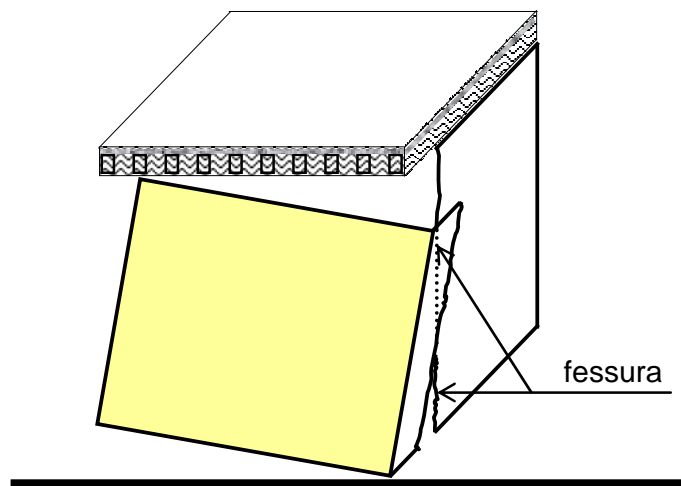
d. L'edificio è assoggettato a un'azione sismica che fa vibrare il paramento murario di figura *c* in condizione di meccanismo rotazionale nel piano del paramento stesso. Al solito, lo schema localizza il perno, anziché diffondere le tensioni di contatto. La rotazione determina una sconnessione tra il muro portante i travetti e il muro ortogonale. La sconnessione consiste solitamente in una fessura verticale nel muro ortogonale. La fessura divide il muro ortogonale in due strisce verticali. La striscia verticale rimasta ammorsata al muro portante i travetti segue monoliticamente la rotazione di questo muro. La striscia verticale centrale del muro ortogonale, stante la sconnessione data dalla fessura, preserva la verticalità, stante la sconnessione determinata dalla fessura. Il cordolo collega i travetti tra loro e perciò i travetti non assecondano la vibrazione del maschio murario. La rigidità flessionale del cordolo impedisce al solaio, dunque, di seguire la rotazione del muro. Il solaio perde così la sua sede naturale d'appoggio, andando a poggiare, da un lato sullo spigolo più alto del muro in rotazione, dall'altro lato sulla striscia di muro ortogonale rimasta verticale.
